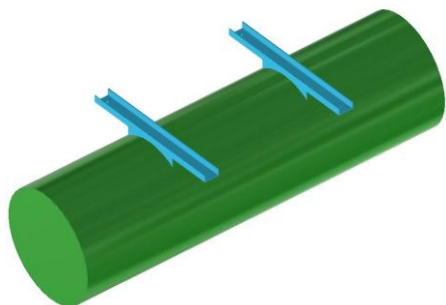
Общий вид наплавной опоры круглого сечения
